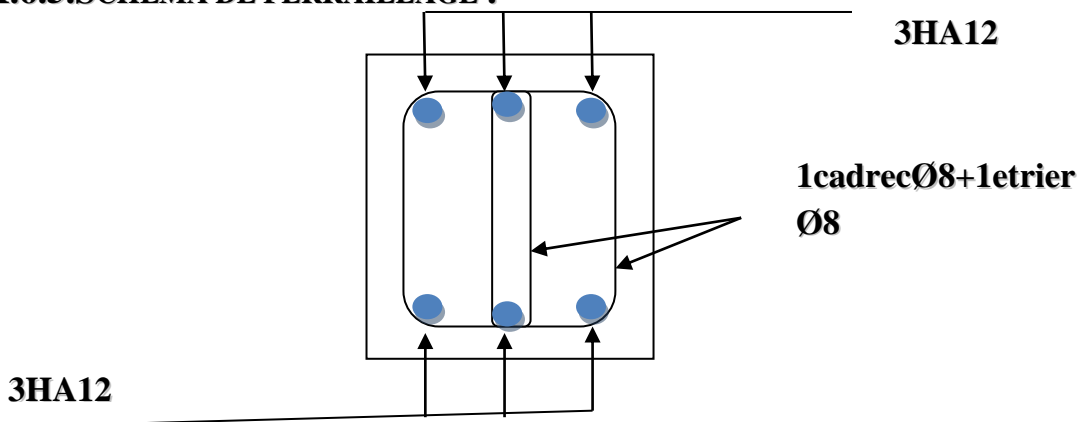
Schéma de ferrailages de la poutre de chaînage
